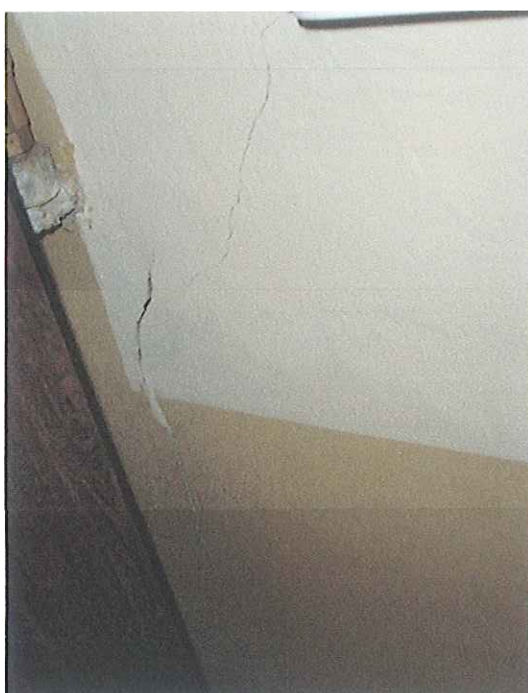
Zarysowanie kozuba lunety w przy wschodnim oknie ściany północnej
